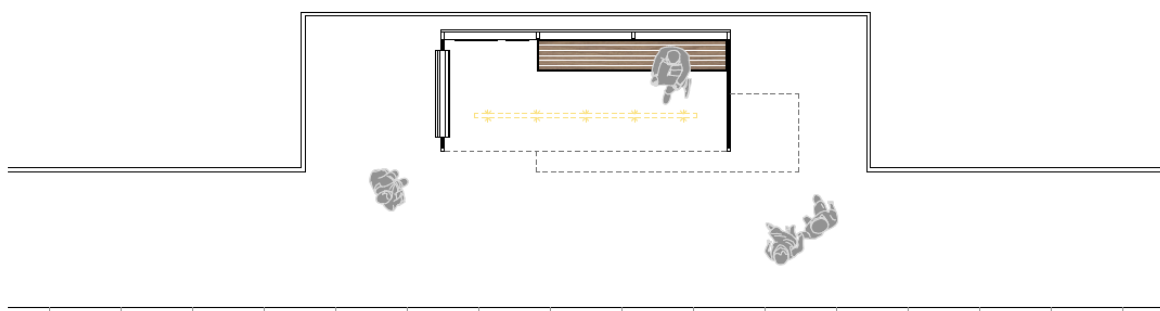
Grundriss/Schnitte Haltestelle Kat. M (ohne Radabstellanlage) © Landesimmobilien Burgenland
